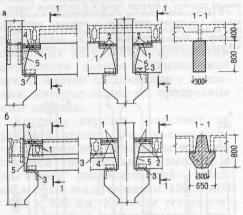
Узлы сопряжений элементов каркаса многоэтажных зданий
